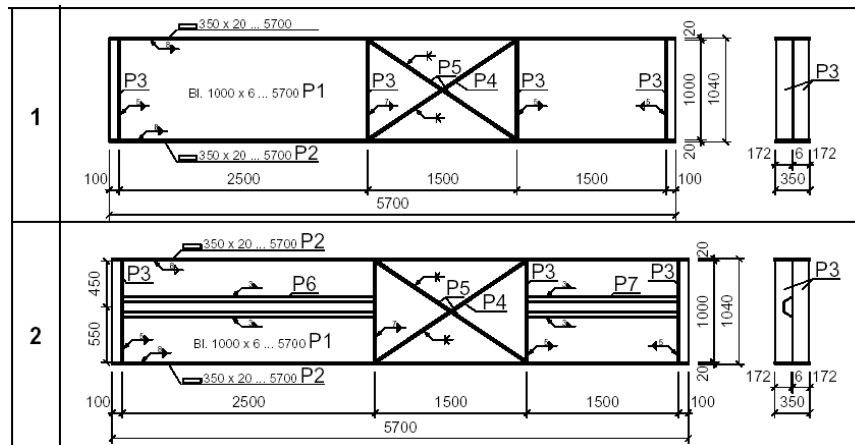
1. Alzados y detalles constructivos de las vigas armadas a ensayar, [COMBRI, 2005a].
